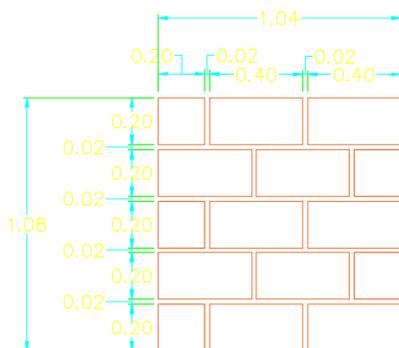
Distribución de mampostería construida con pega tradicional.
